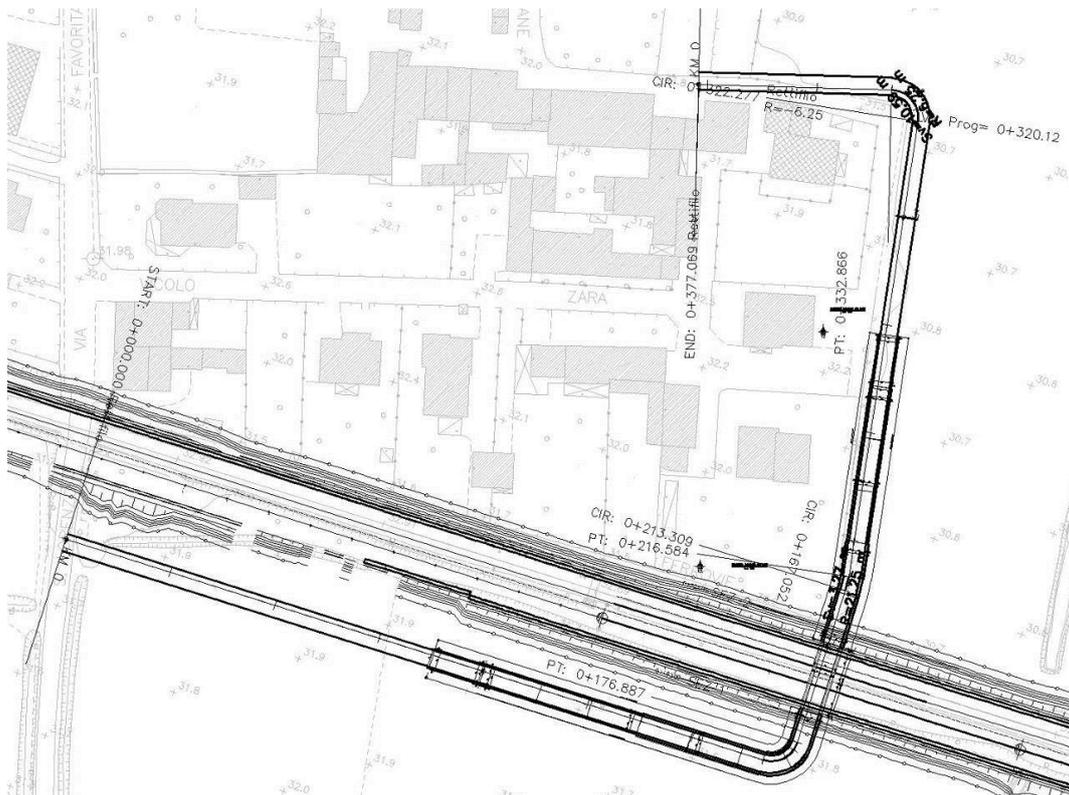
inquadramento planimetrico pista ciclo-pedonale
